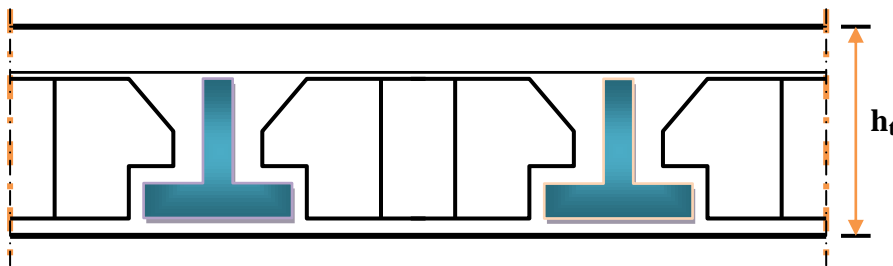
Coupe transversale d'un plancher à corps-cieux.
